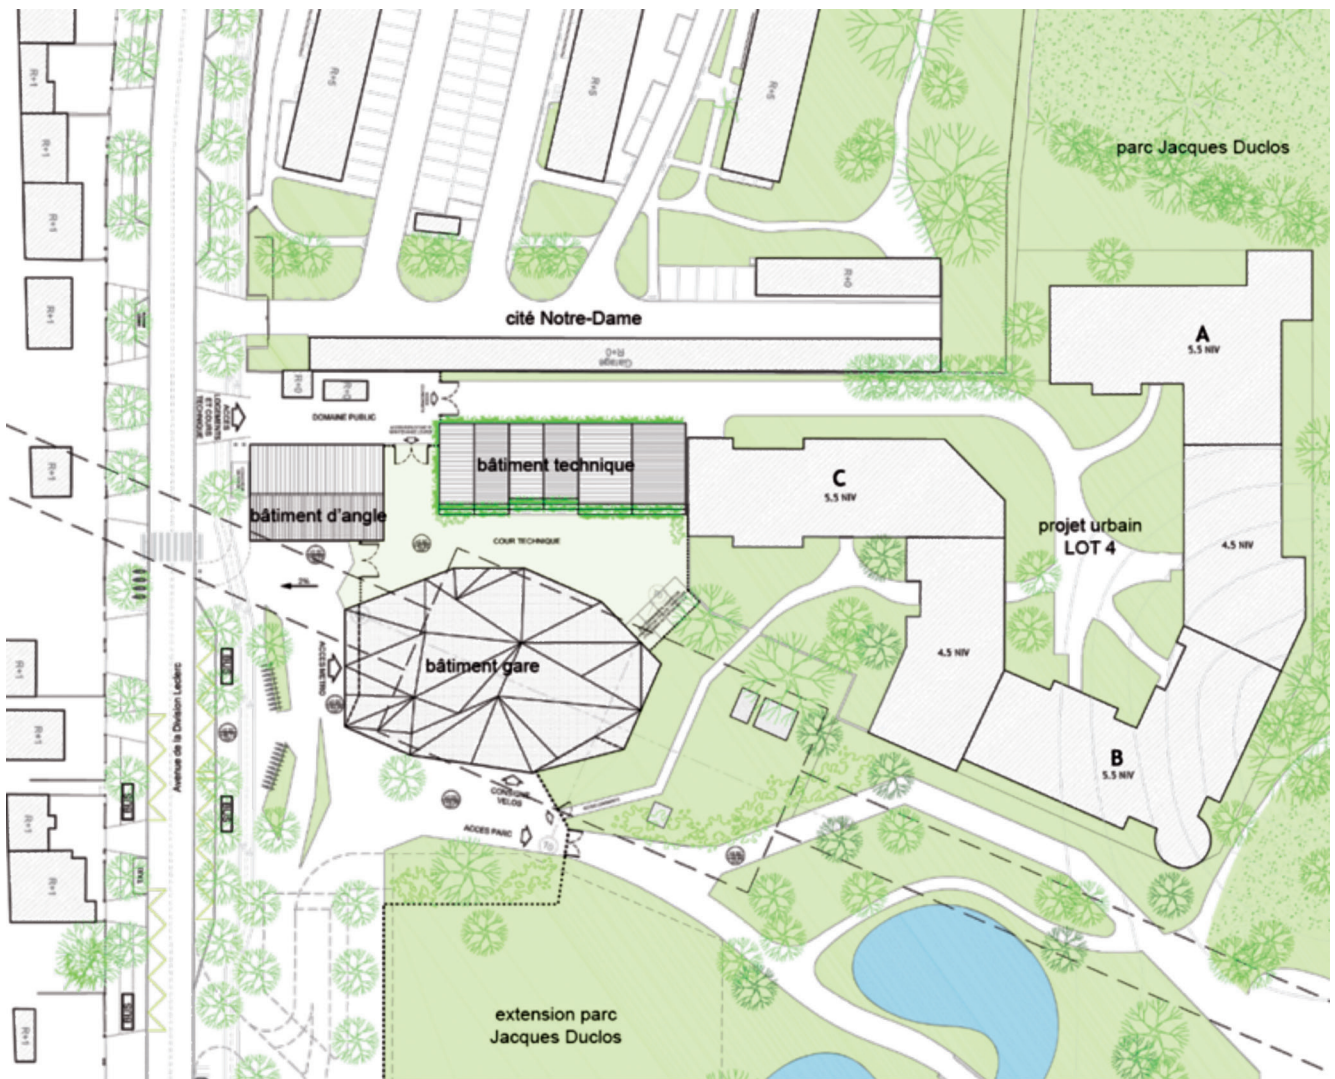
Plan d'implantation du projet de la Gare associé au projet urbain de la ville
